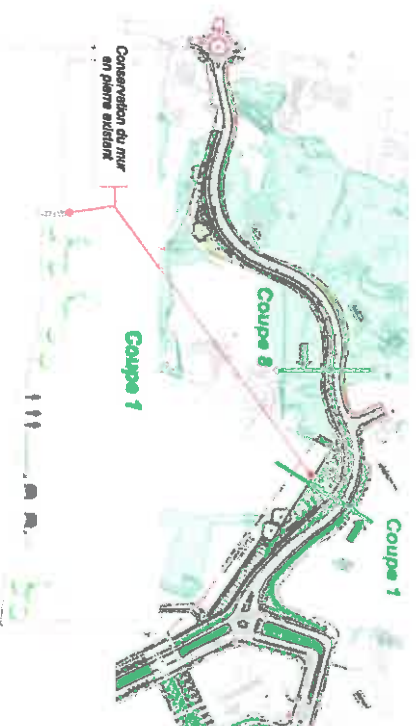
Vue en plan de la séquence de la voie nouvelle de traversée de parc (source : AVP du groupement Arcadis)
